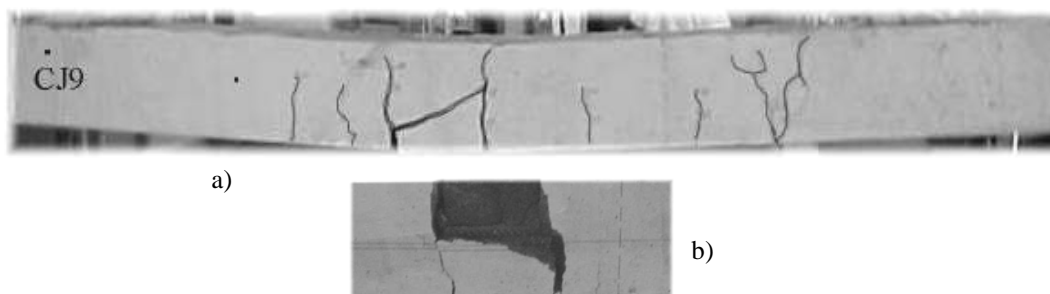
Viga *CJ9* – a) vista lateral – b) vista da ruptura de fundo.
